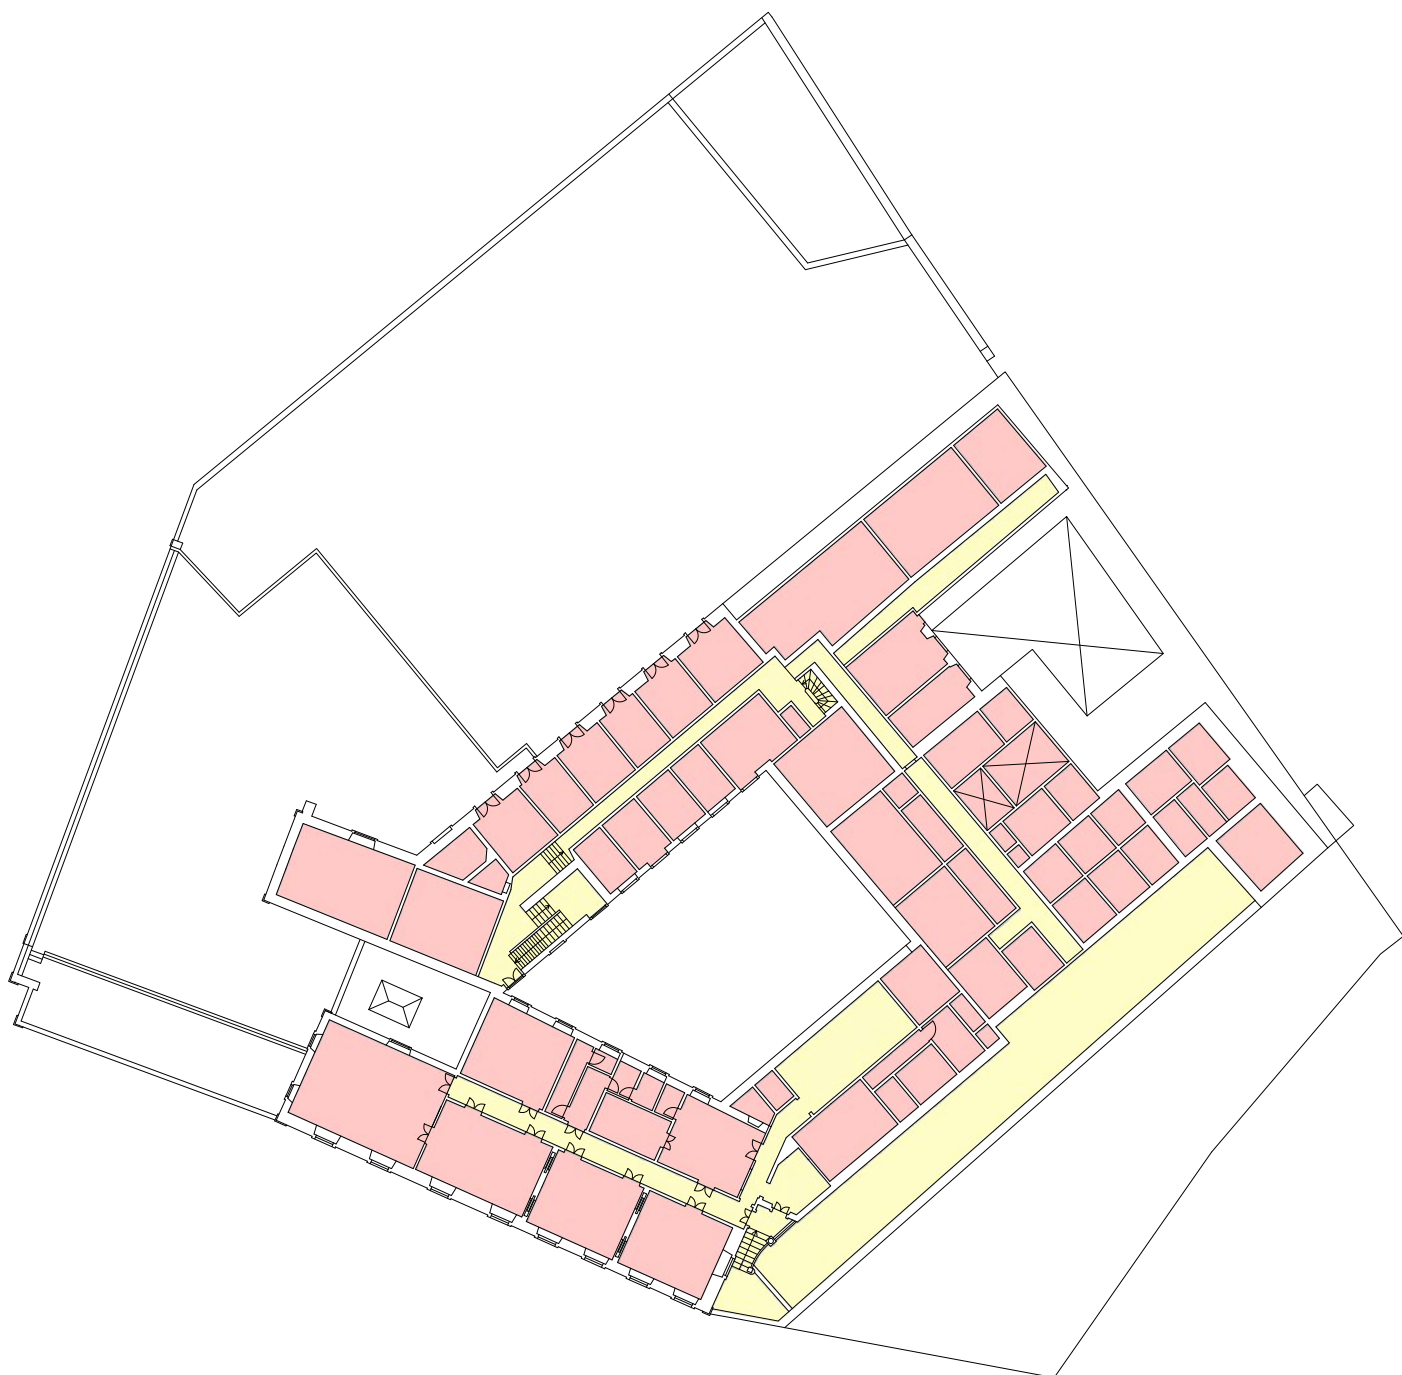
Planta original do piso I, à escala 1:500, orientada a Norte
